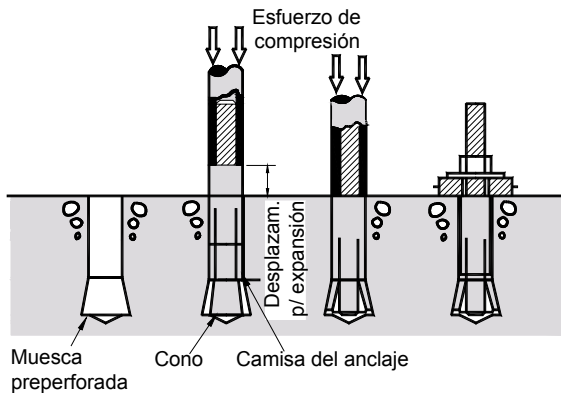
(b) – Anclaje rebajado Tipo 2: Anclaje de desplazamiento controlado que se instala en una muesca rebajada preperforada martillando la camisa sobre el cono
